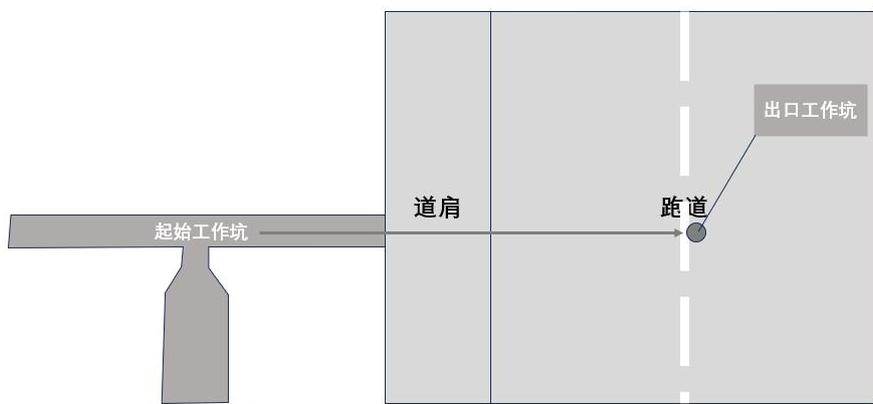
水平定向钻施工平面图示意图 (跑道为例)
